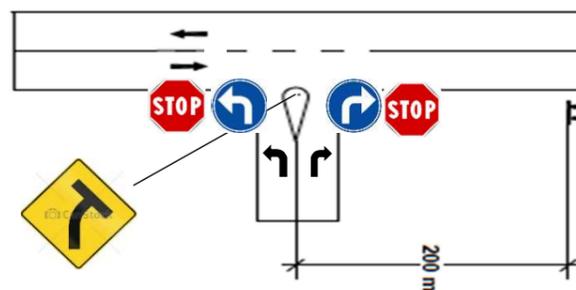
Propuesta de intersección en planta de la CV-570 con la nueva "arteria principal".
